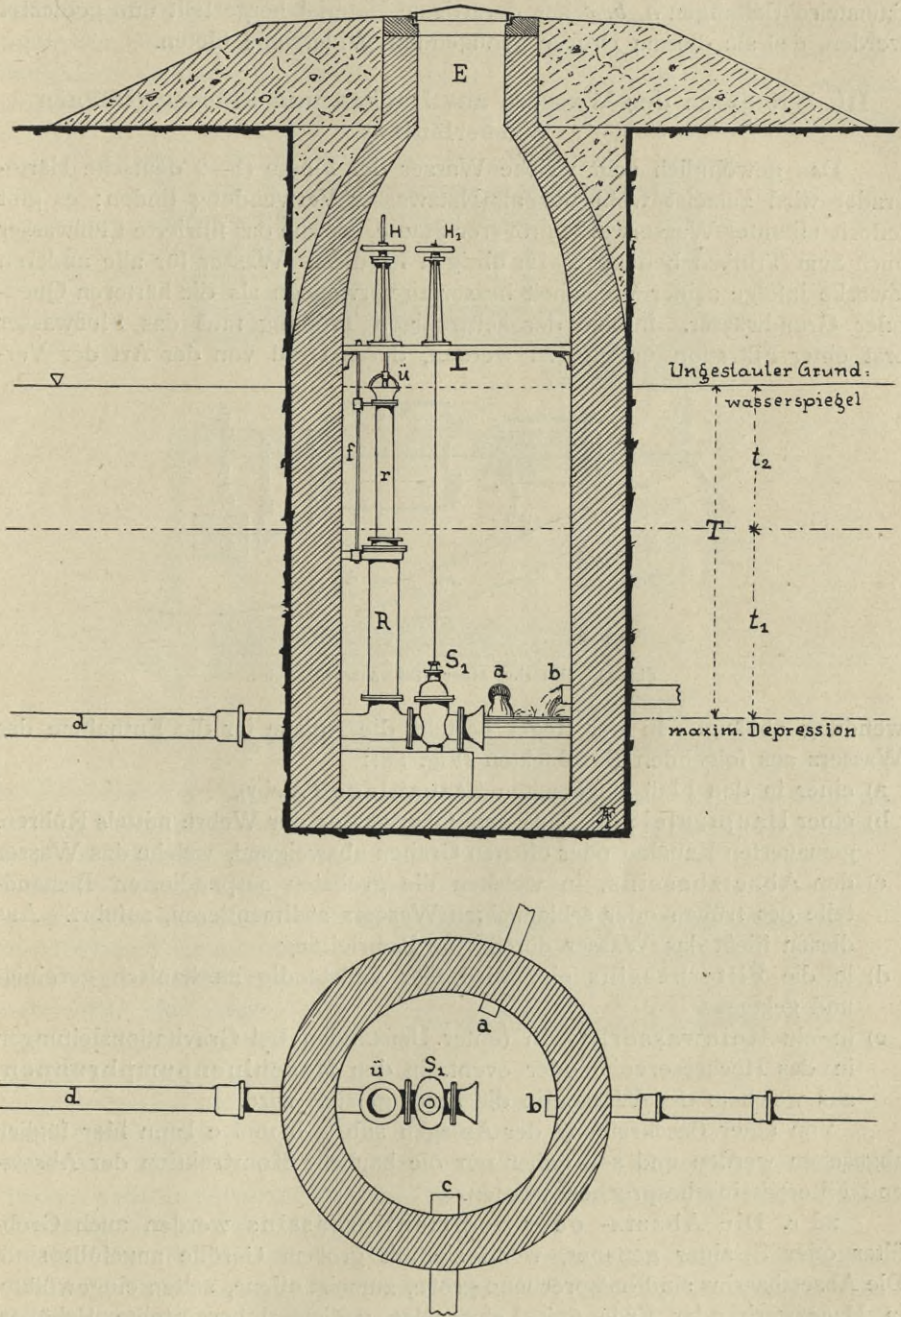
Sammelbrunnen mit Einrichtung zur Erzielung variabler Grundwasserabsenkungen.
